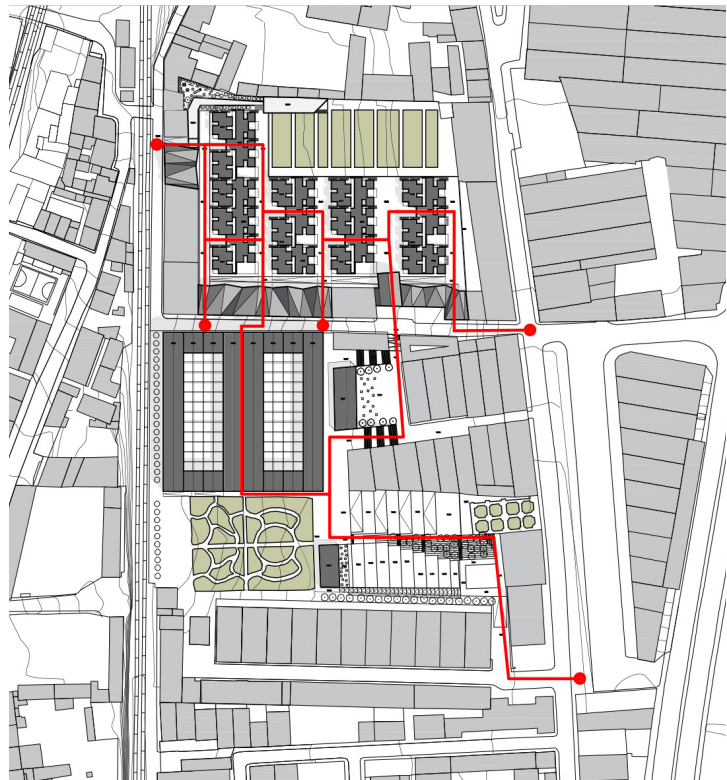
Planta do Local de intervenção Atravessamentos sugeridos com a nova proposta
